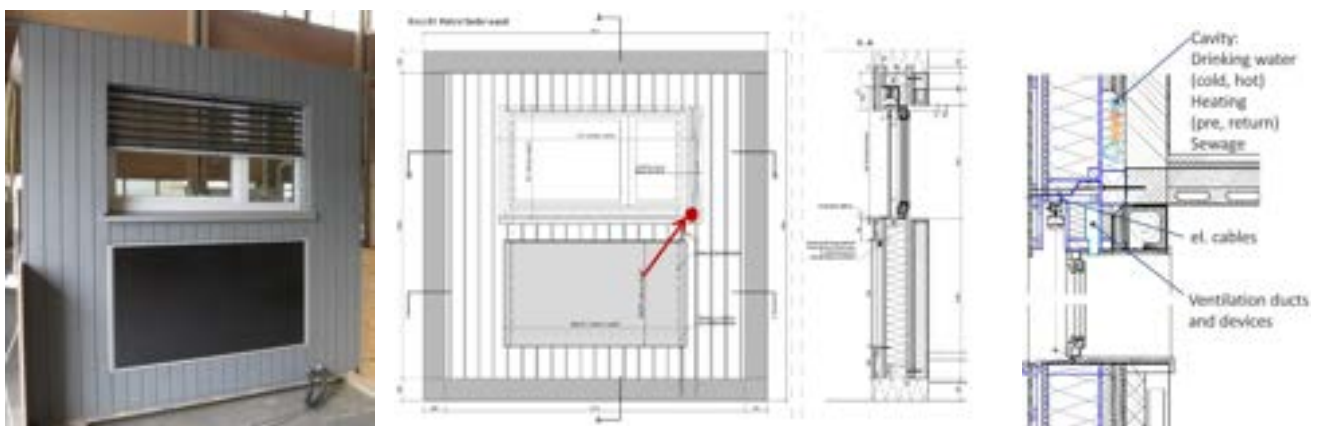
Progetto 4RinEU – Prospetto, rendering e sezione del modulo prefabbricato
